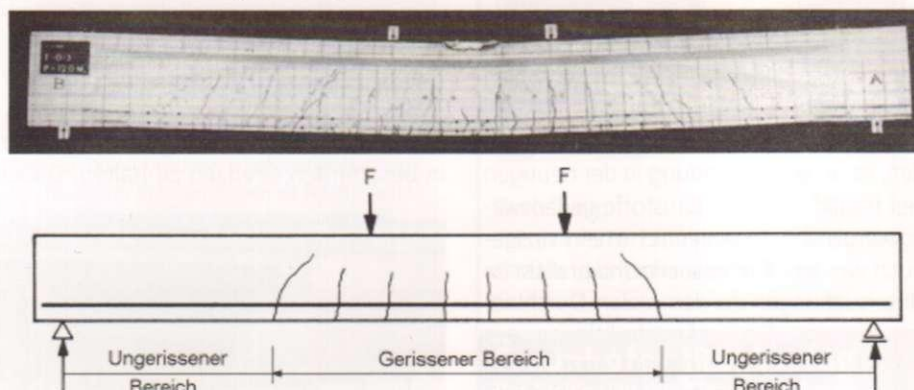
Gerissener und ungerissener Bereich eines Stahlbetonbalkens, [2]
